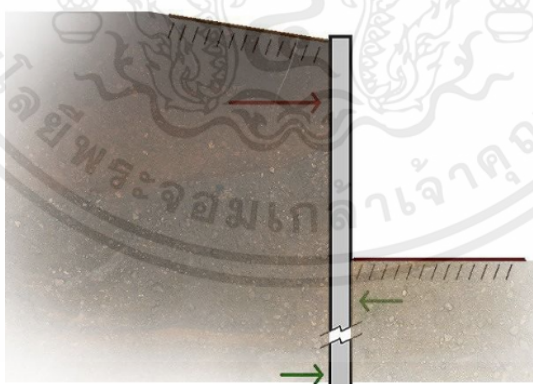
กำแพงกันดินแบบคานยื่น Cantilever wall
